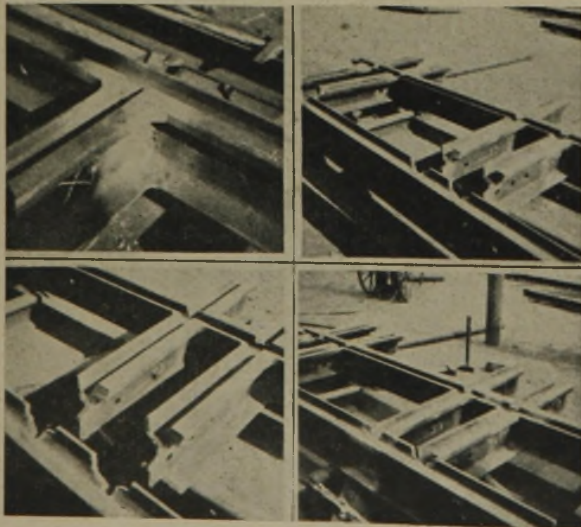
Schweißen einer Auflauf-Rillenschienenkreuzung
